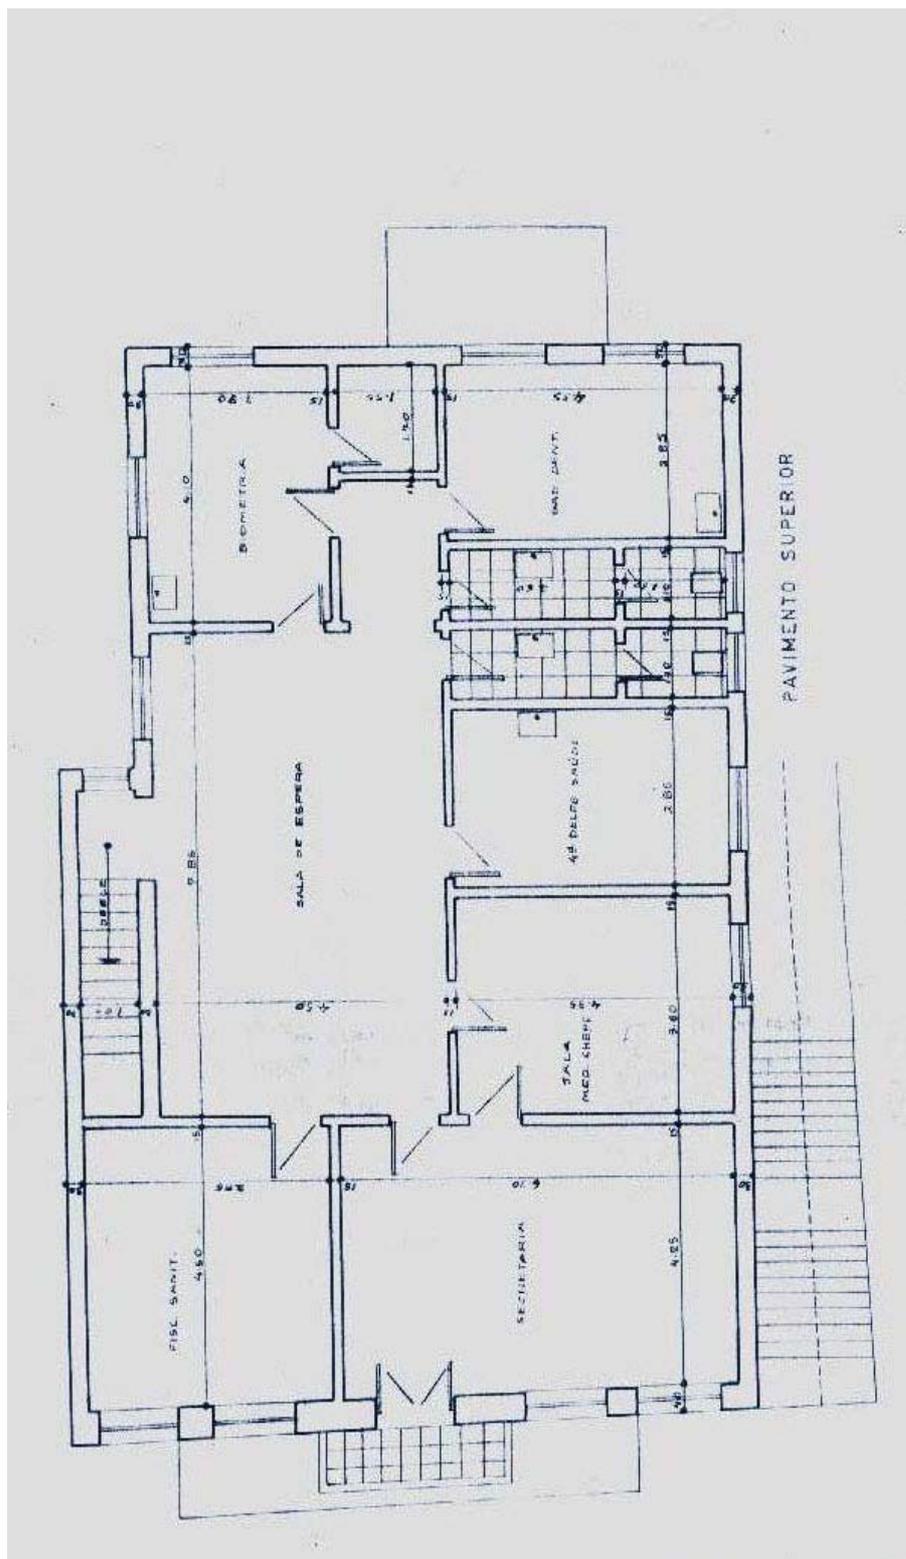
Planta do Posto de Saúde em 1969 (2º. pav.)
